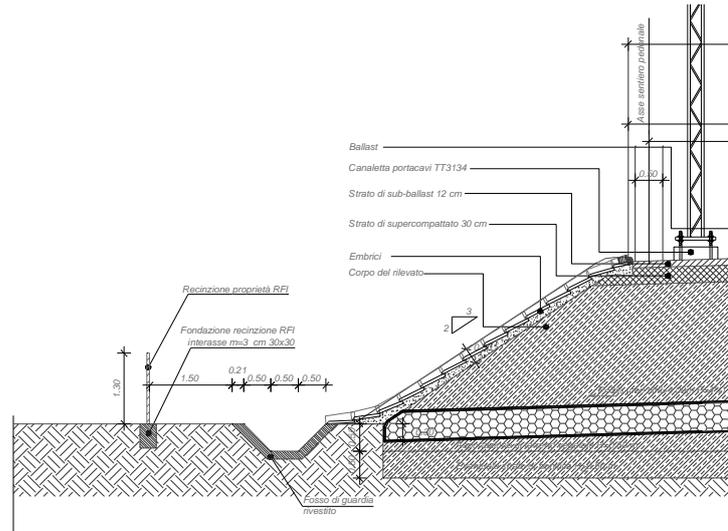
Dettaglio alla base del rilevato ferroviario
